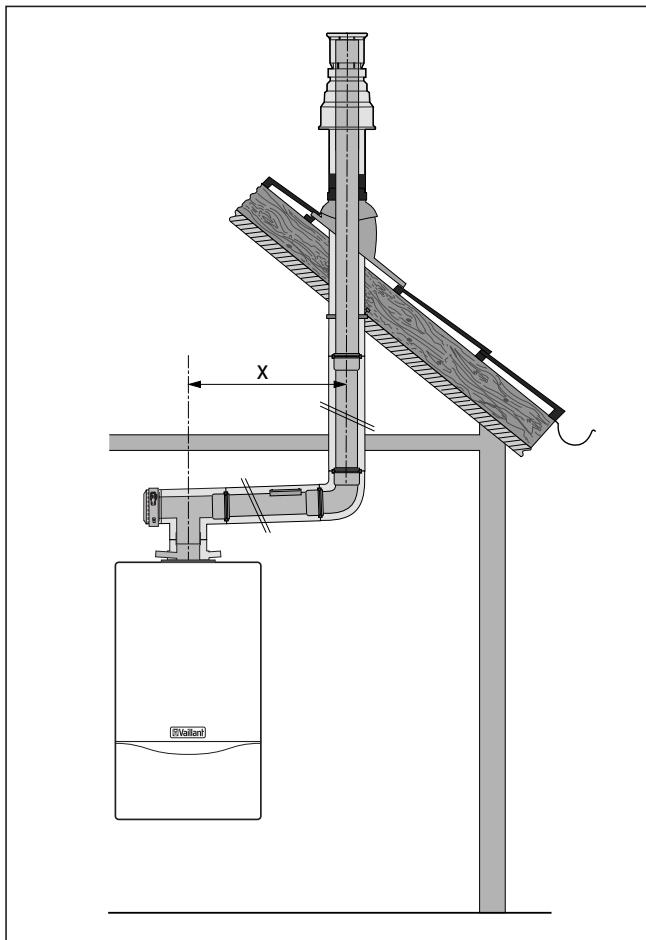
Пример монтажа: вертикальный ввод через кровлю
